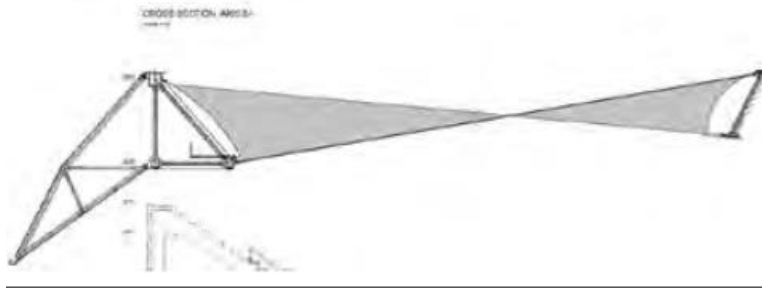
Vista en perfil de la estructura de la cubierta. Tomado de (Marzo, n.d.)
